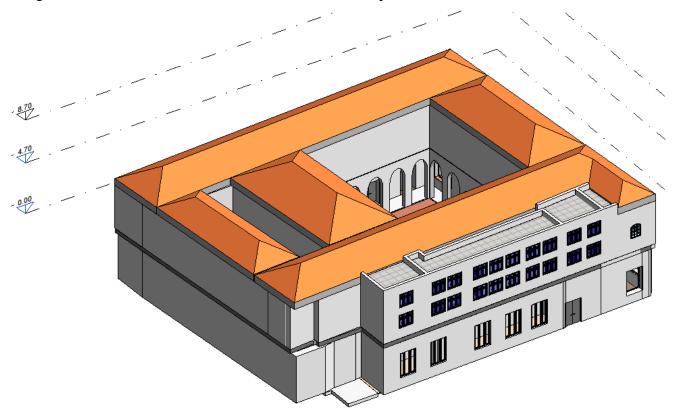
Modelado 3D – Fuente: Elaboración Propia
